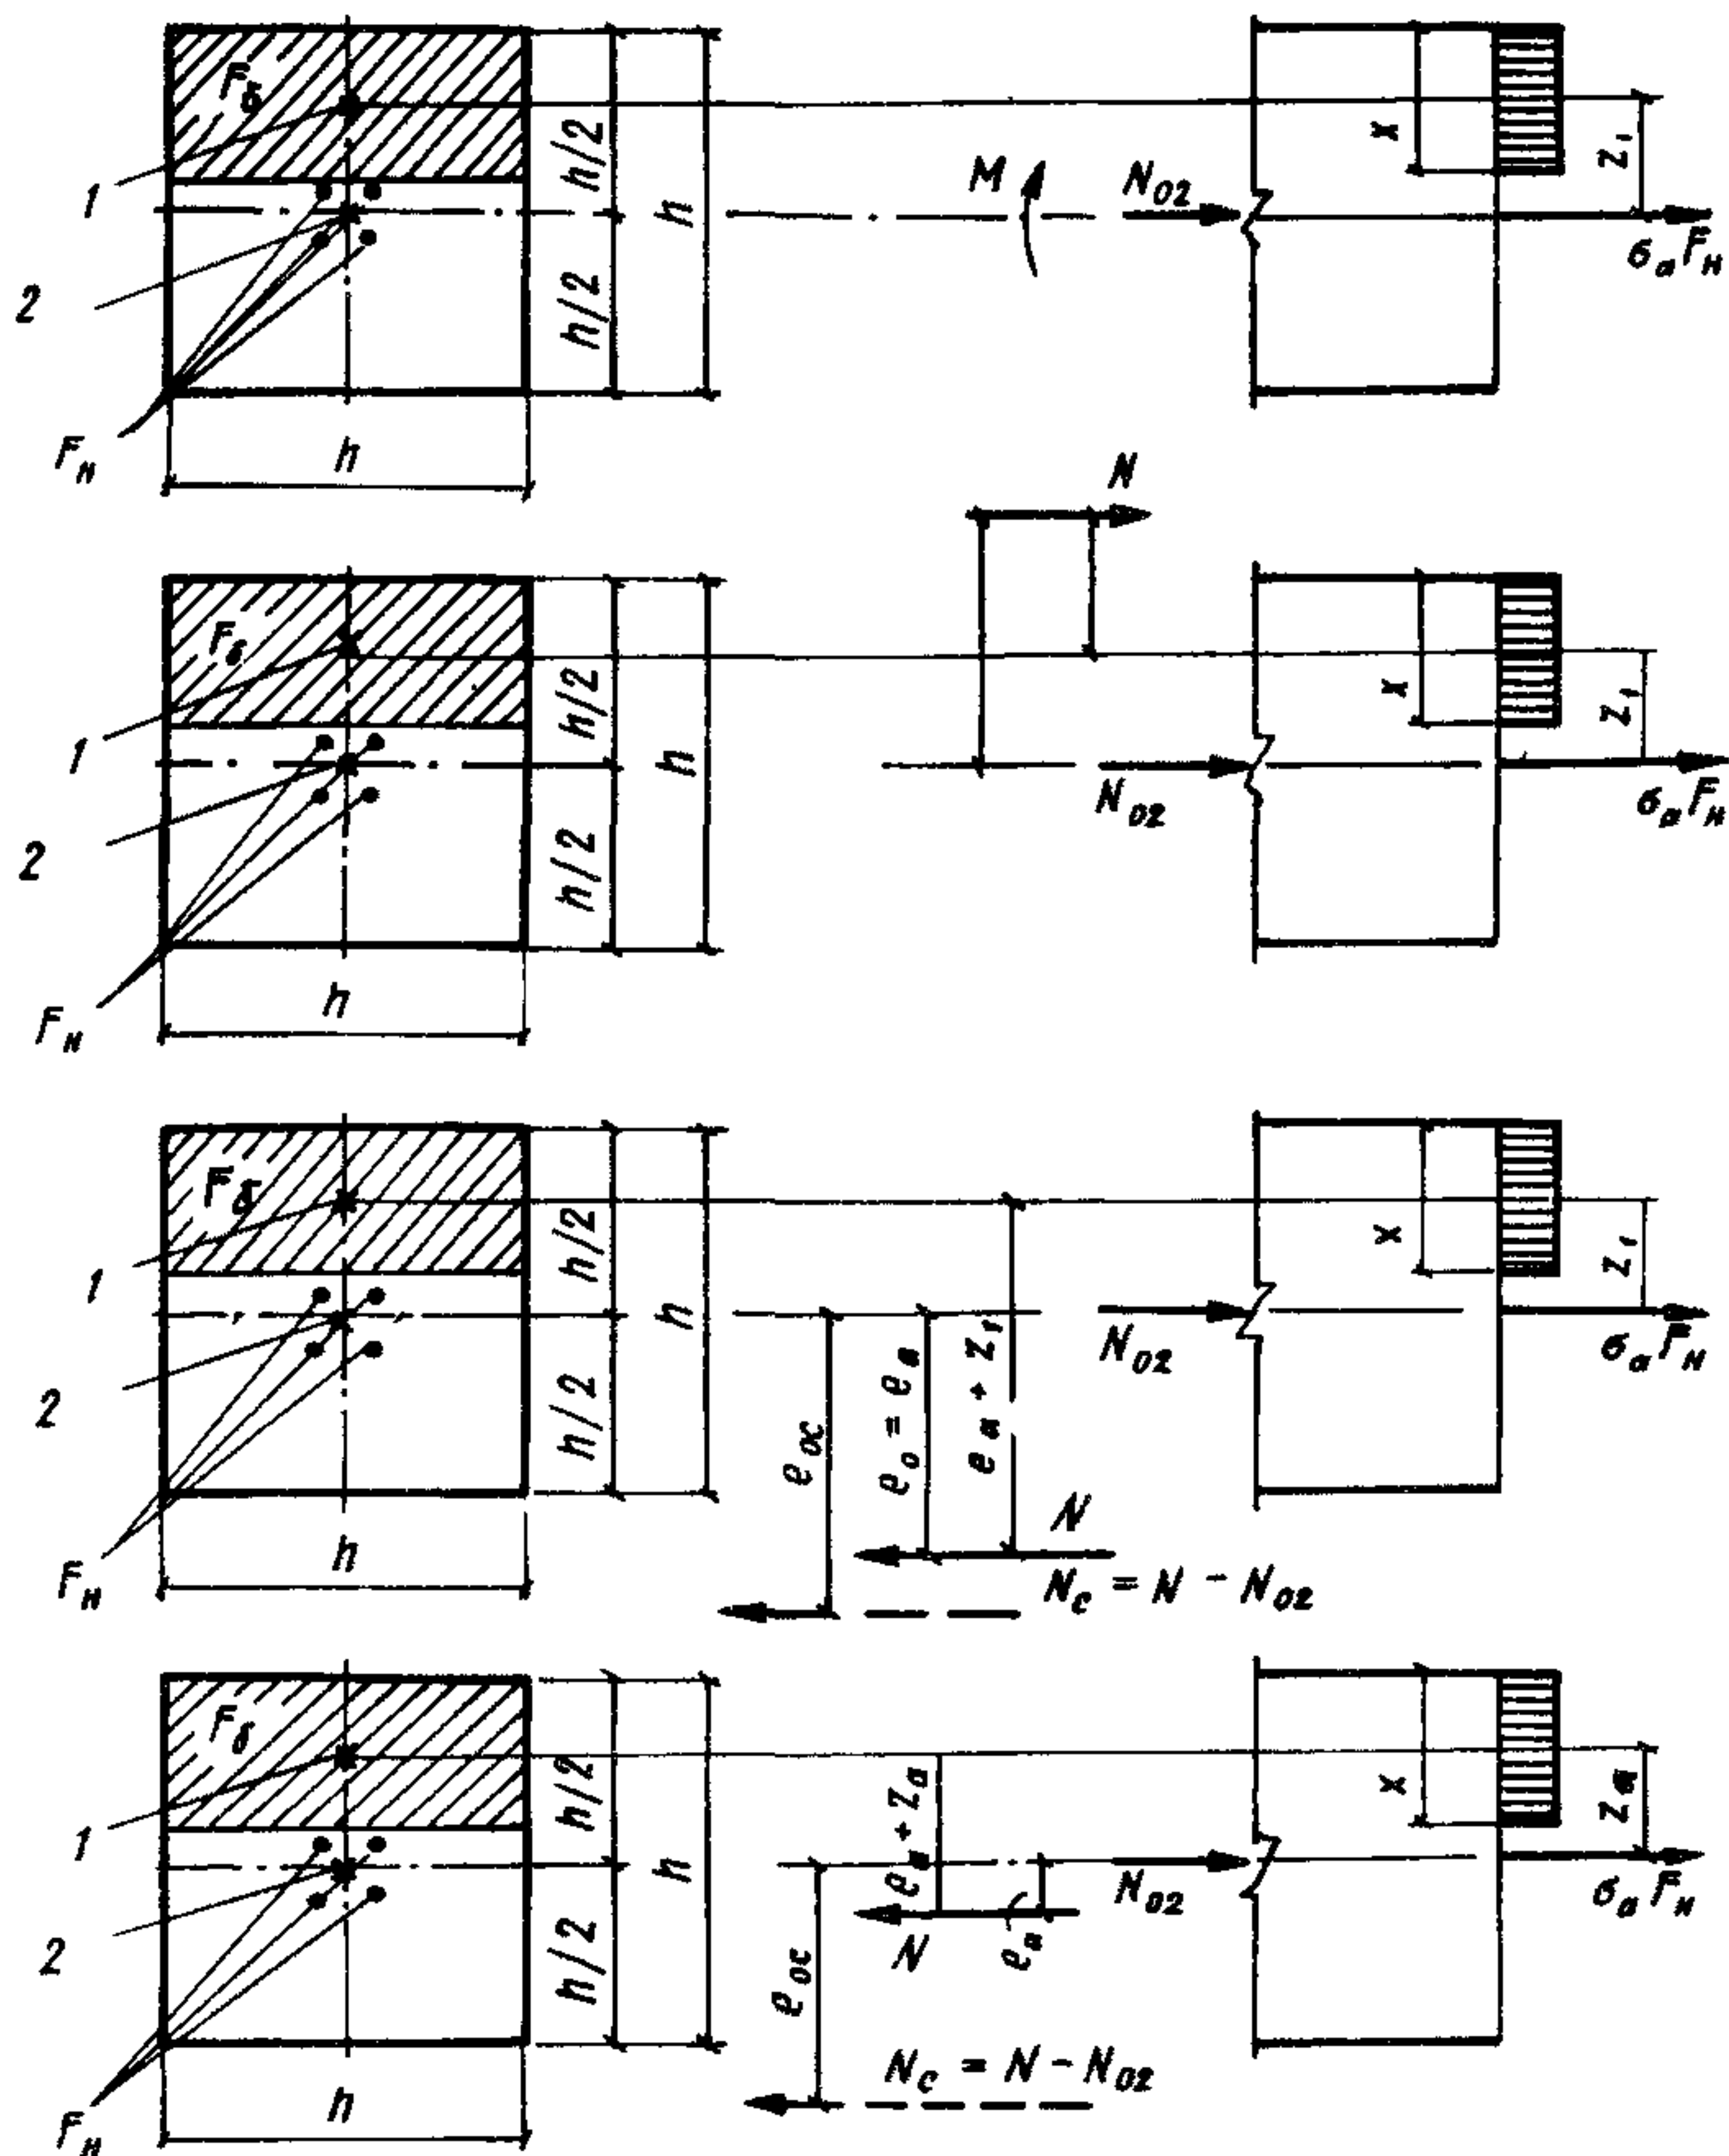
Схема усилий и эпюра напряжений в поперечном сечении сваи при его расчете по ширине раскрытия трещин, нормальных к продольной оси сваи
